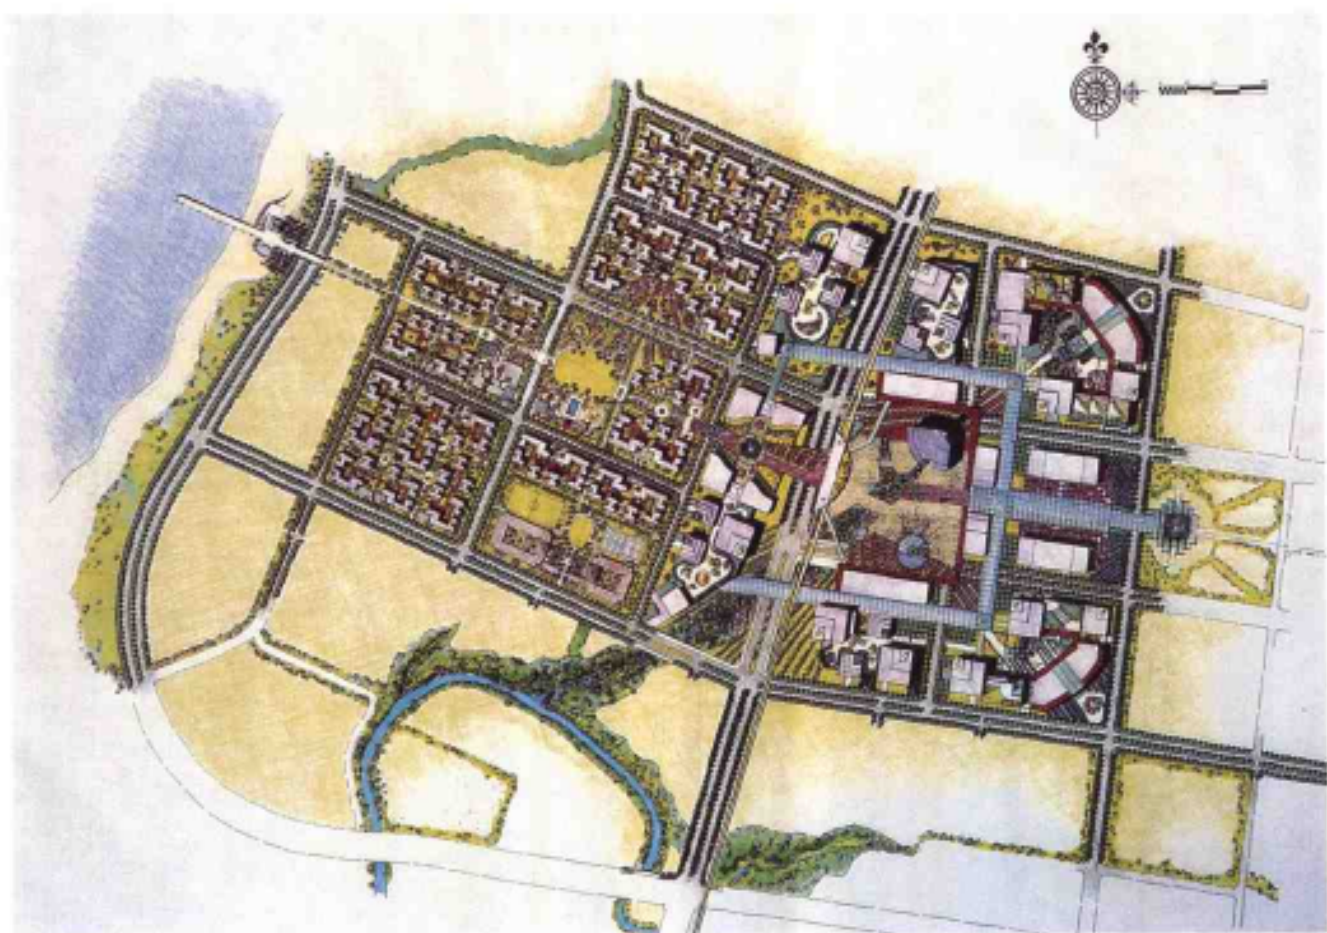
台湾淡海市新市镇规划总平面图
